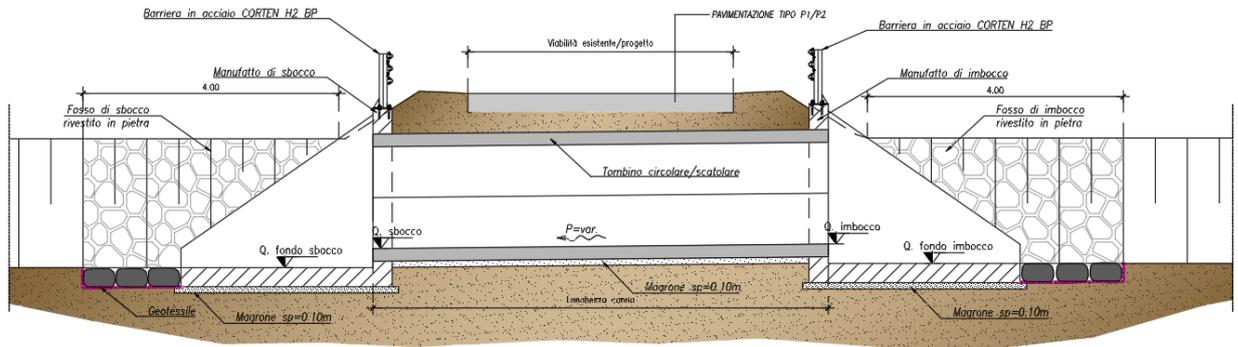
Sezione tipo su manufatto idraulico – Barriere tipo H2 BP in legno con anima in acciaio
